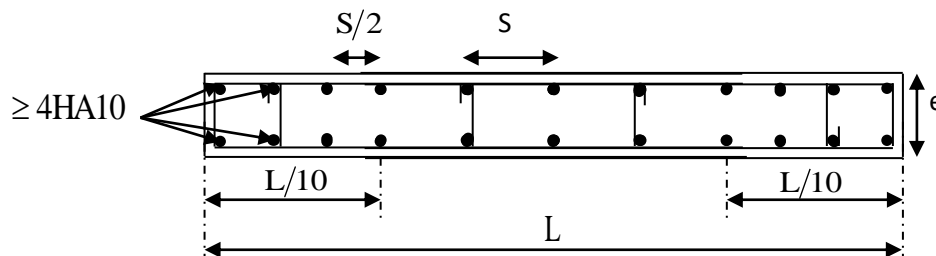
Disposition des armatures verticales dans les voiles.
